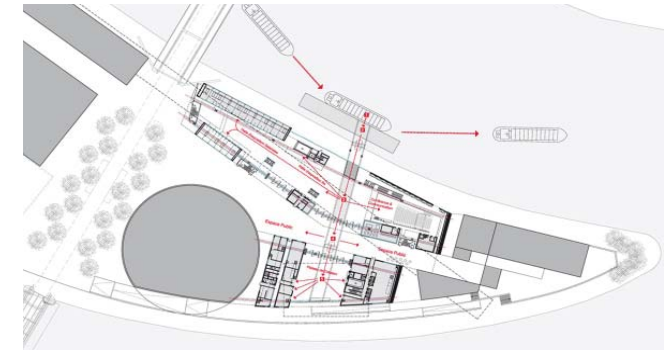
Lageplan des Projekts 'R4' Jean Nouvel
